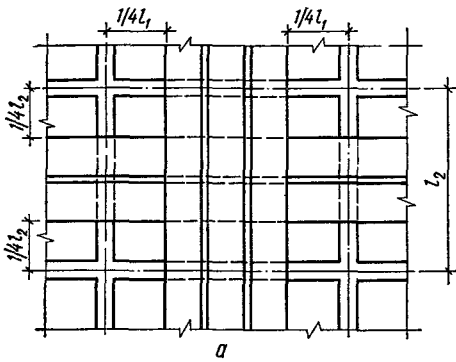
Схема армирования плиты, опертой по контуру, сварными рулонными сетками:
